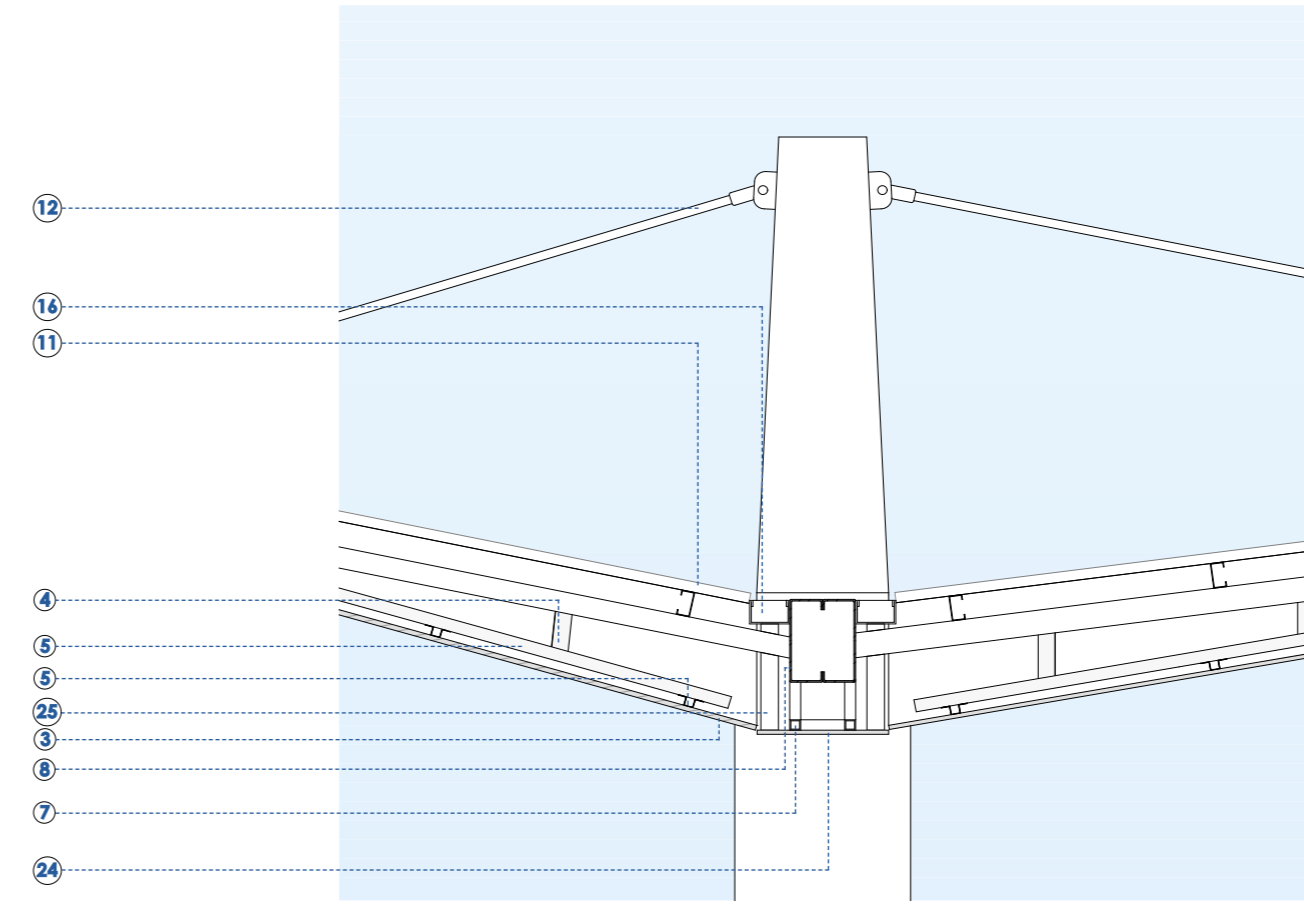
Detalle Constructivo C-2. Fuente: Elaboración propia (2026)
